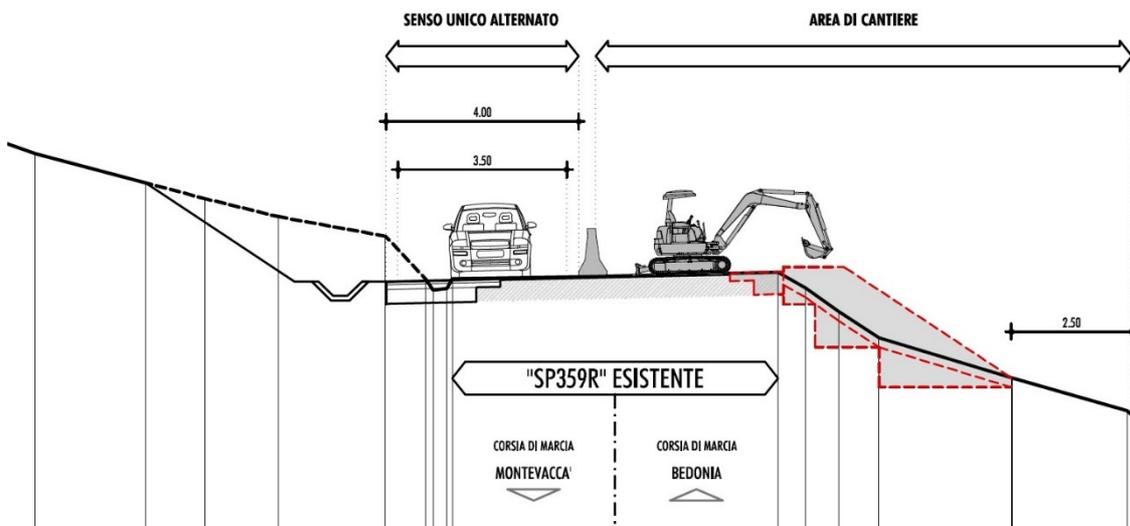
TRATTO 1, FASE 2: TRAFFICO SU CORSIA DI MONTE (ESTRATTO DALL'ELAB. PD.04.04)
